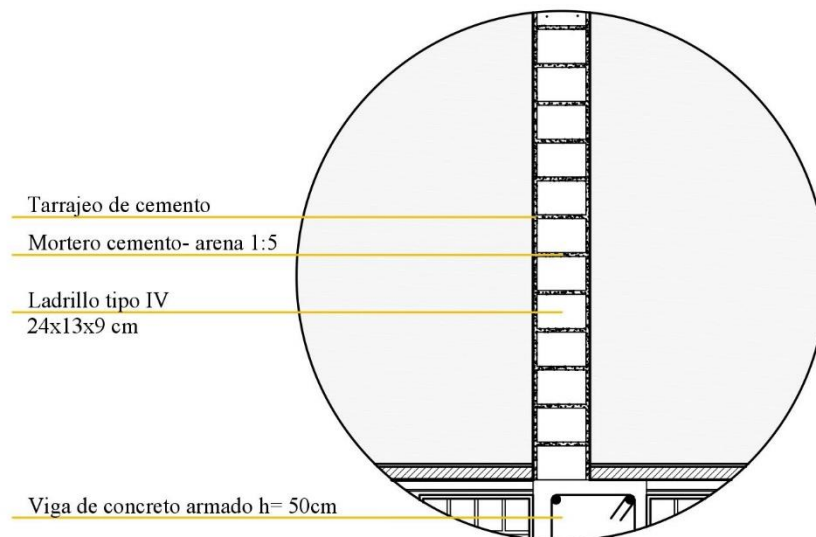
Detalle de muro de albañilería de soga. Fuente: Propia
